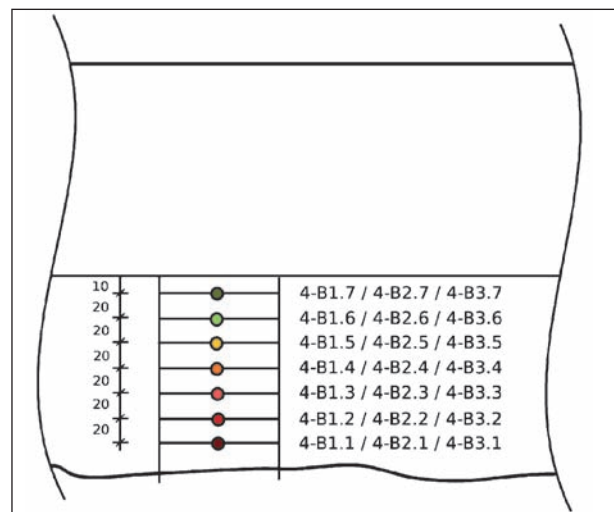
Soll-Einbauzustand sowie Bezeichnung der Thermolemente Probekörper RUB 2
